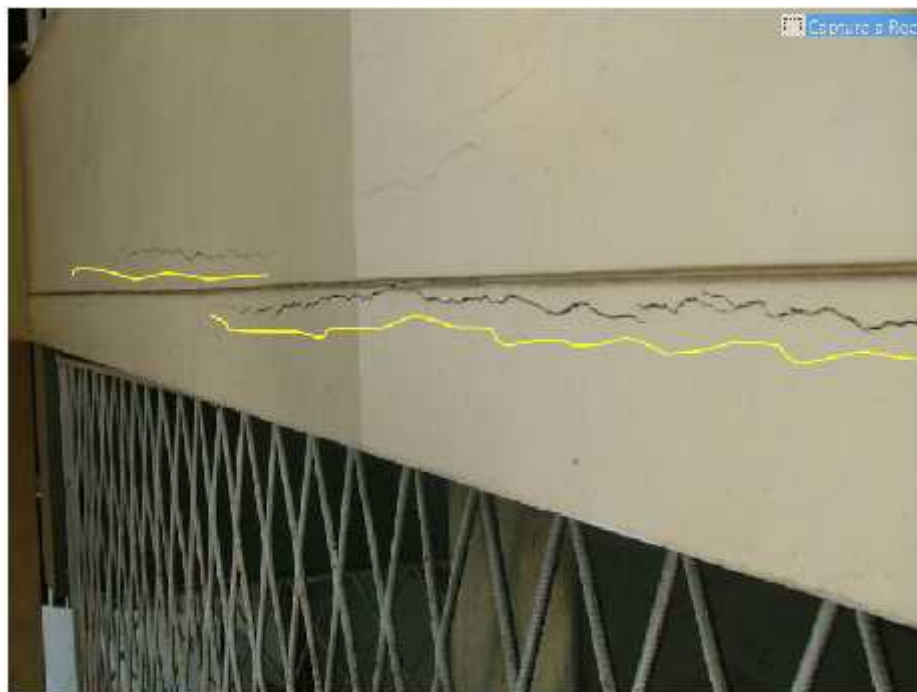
Fissuração horizontal junto a laje do corredor de acesso aos fogos, repetindo-se em quase todos os pisos.
